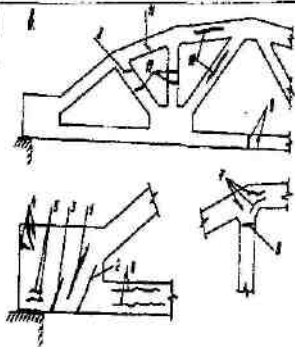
Схема разрушения в сжатой зоне бетона при потере устойчивости стержнями сжатой арматуры:
